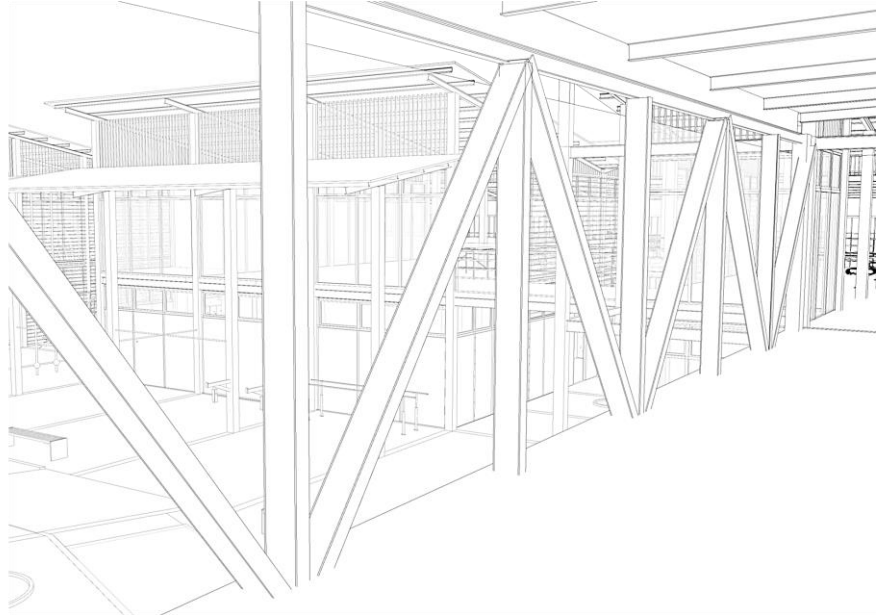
Vista desde el puente de conexión entre los dos bloques principales
